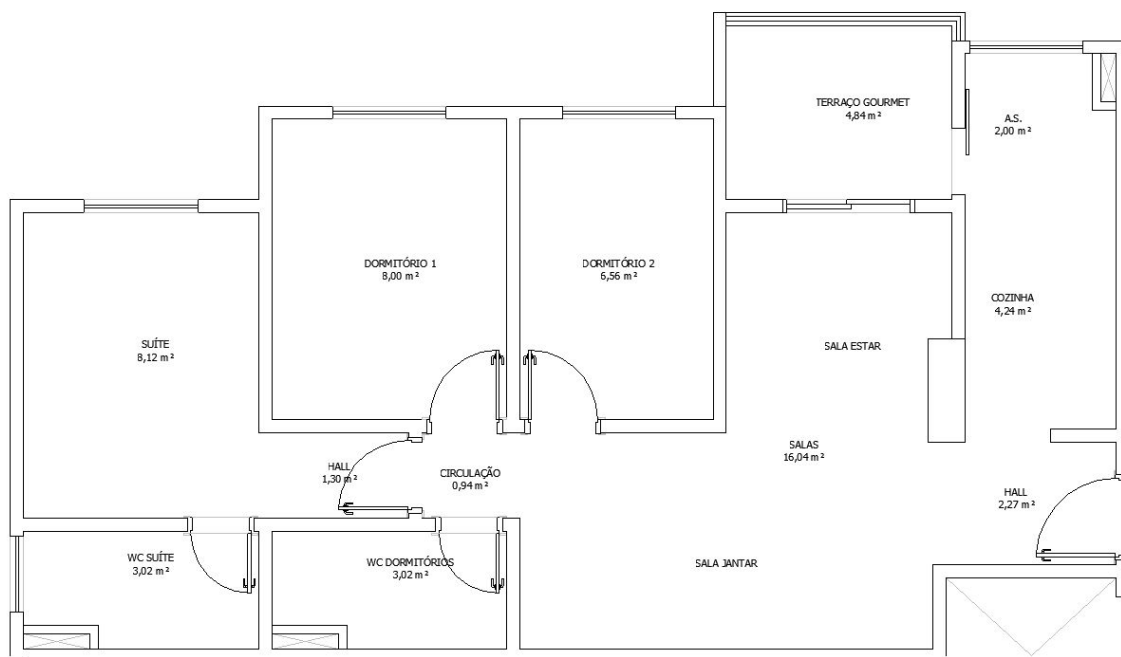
Blocos 1, 3 e 5 – planta apartamento 2 dormitórios e 1 suíte.
